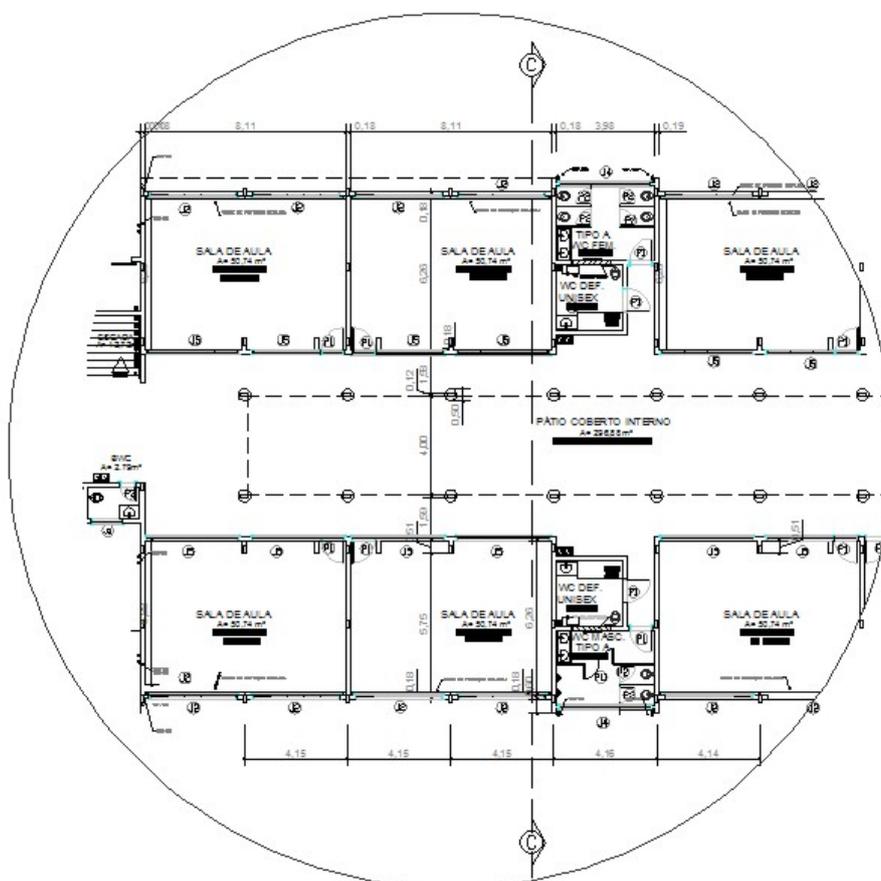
Escola Padrão-projeto de 2001 - Planta Baixa Pavimento Térreo.
